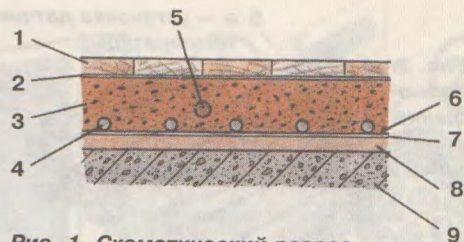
Схематический разрез теплого пола на бетонном основании: 1 — наружный слой нового пола (плитка, паркет, линолеум); 2 — слой гидроизоляции; 3 — бетонная стяжка или слой мастики; 4 — кабель нагревательной системы; 5 — температурный датчик; 6 — монтажная лента для крепления кабеля; 7 — слой теплоизоляции; 8 — слой теплоизоляции; 9 — существующее бетонное основание.
